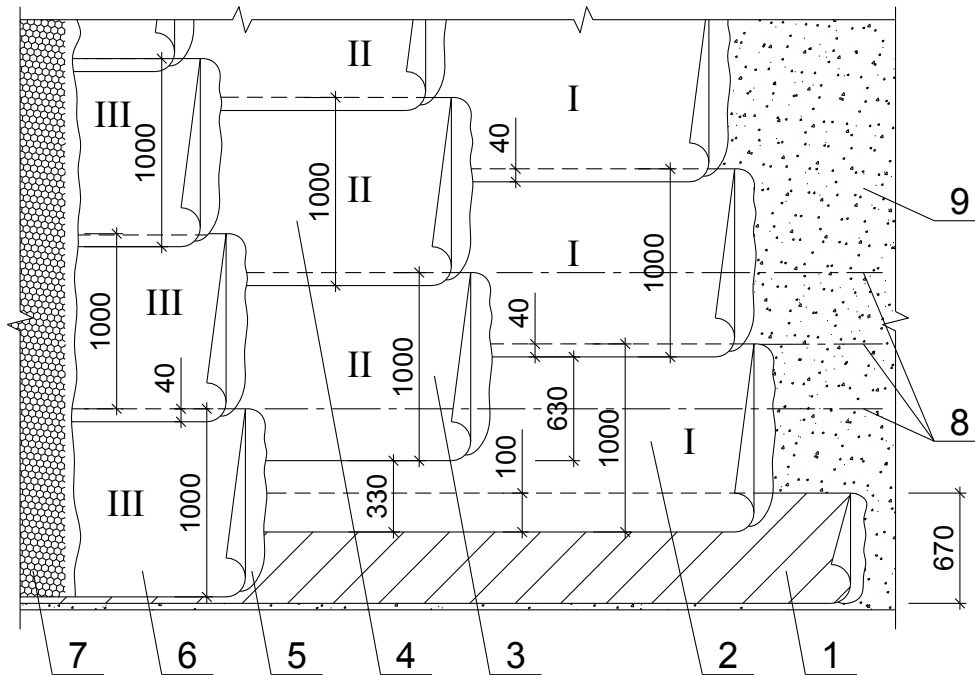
Устройство двухслойной рулонной кровли
